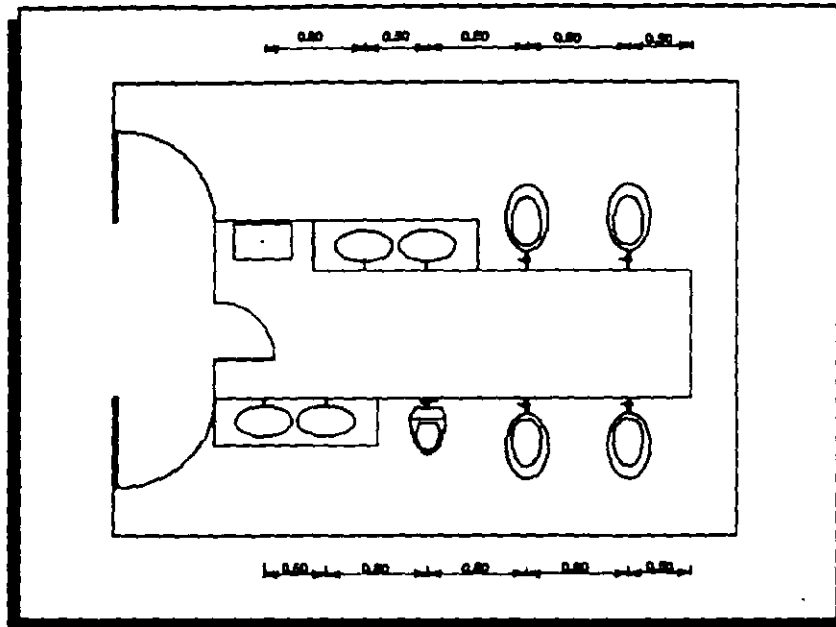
Planta arquitectónica de los sanitarios del ejemplo 5.1.
